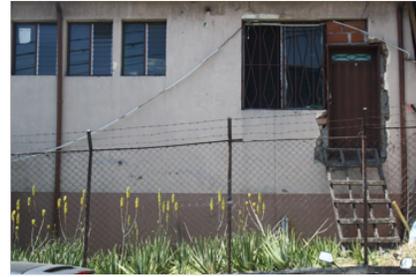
Fachada. Barrio San Javier, Medellín (2017).
